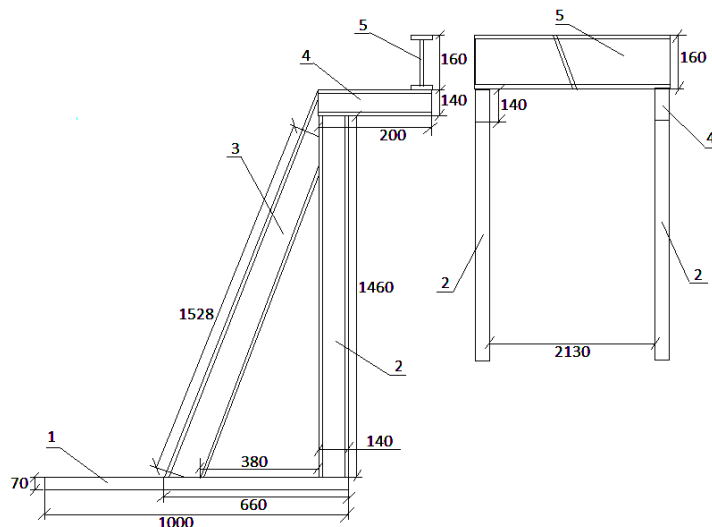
Обмерочный чертеж узла крепления тали г/п 3 т. зав. № xxxx
